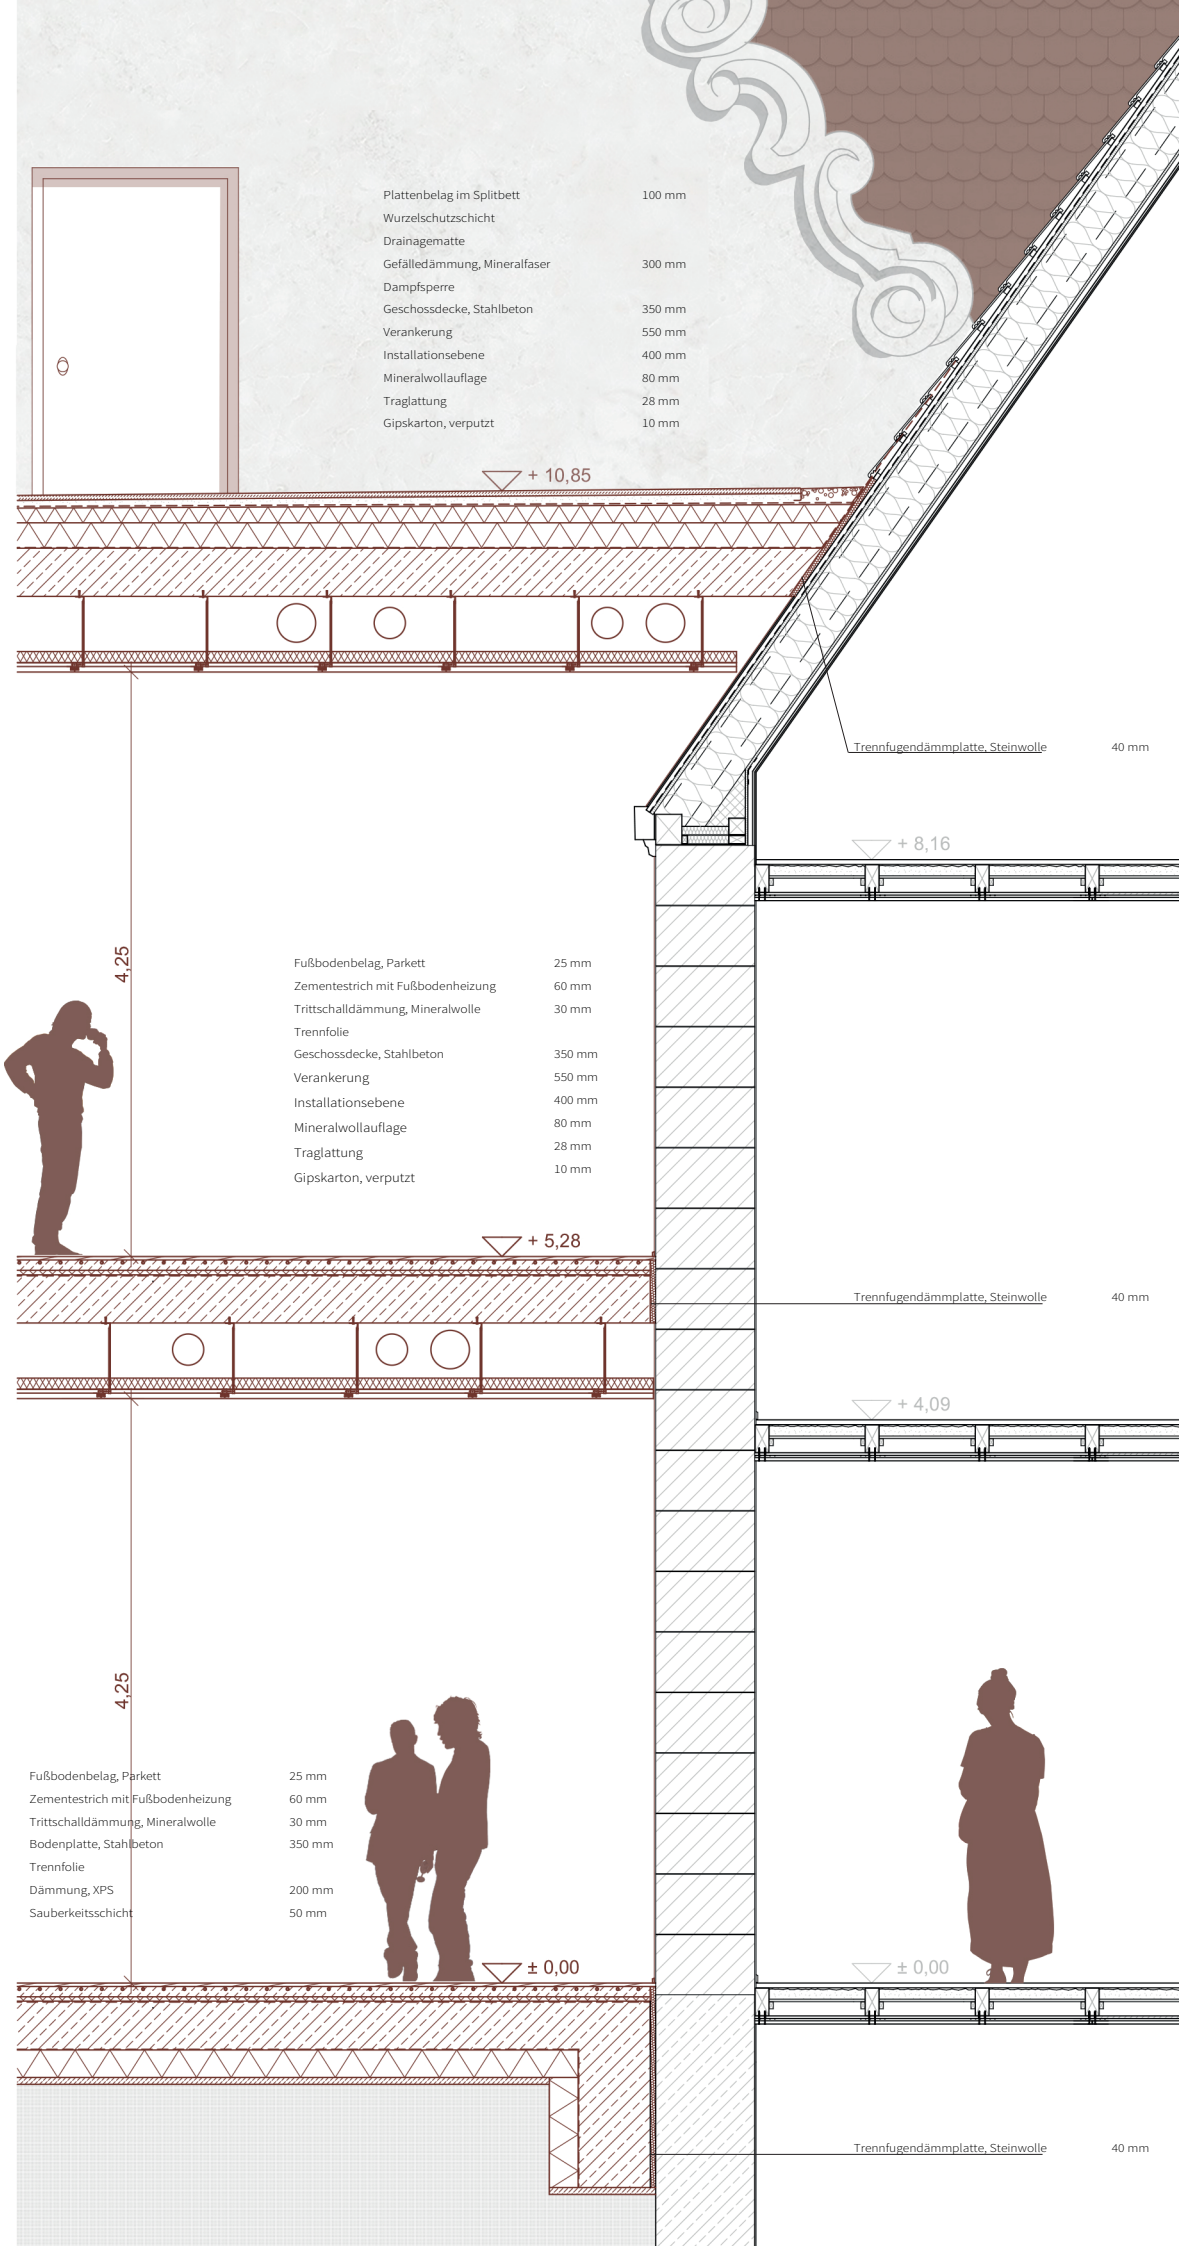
Fassadenschnitt & Ansicht, M 1:55
